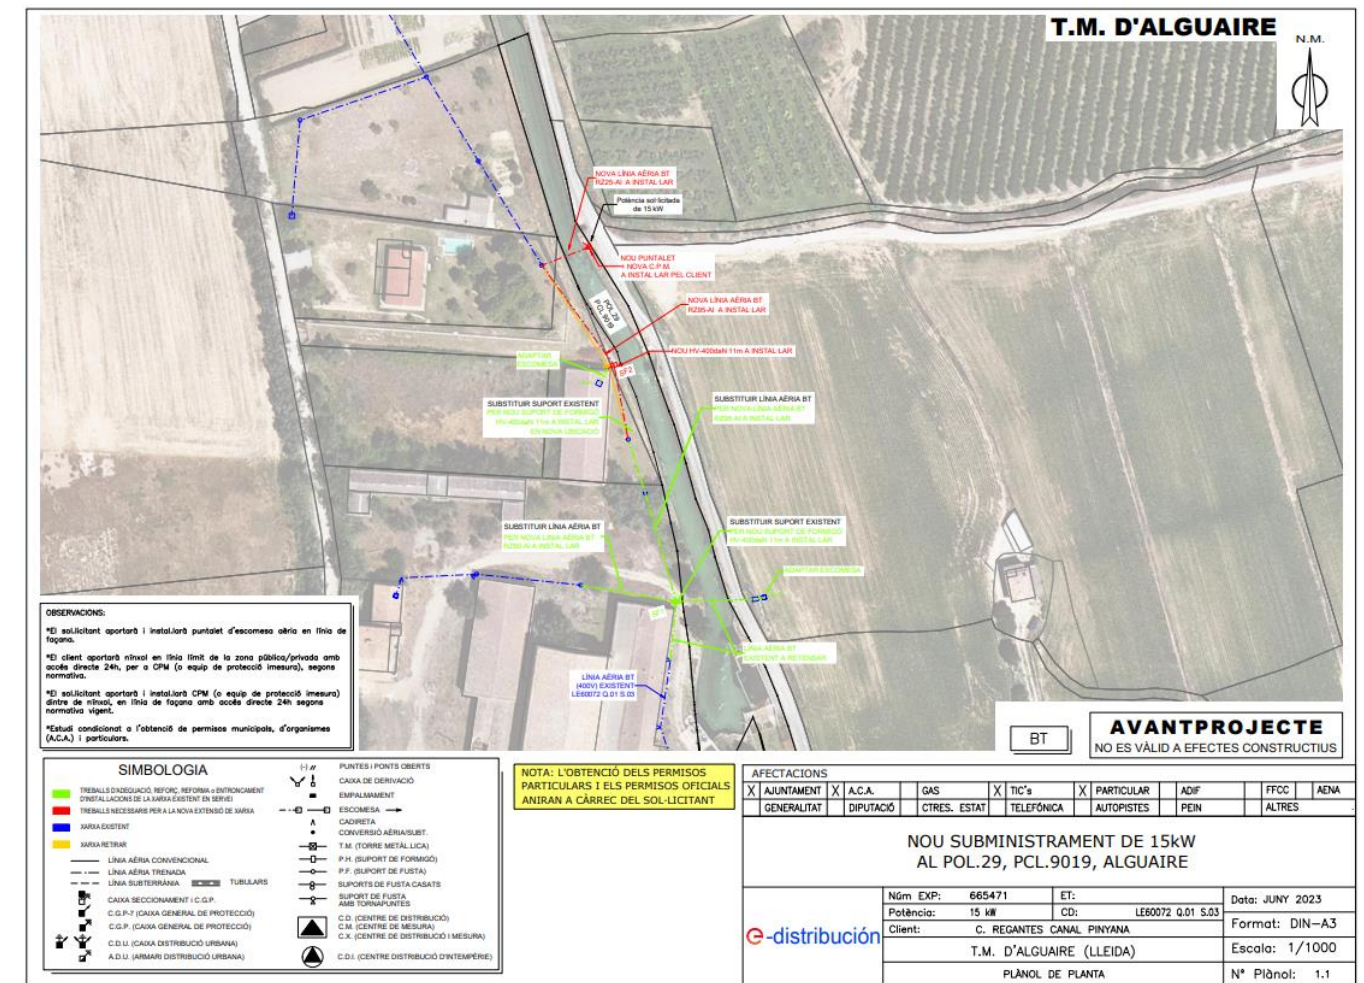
Plano de planta del nuevo suministro de 15 kW.
